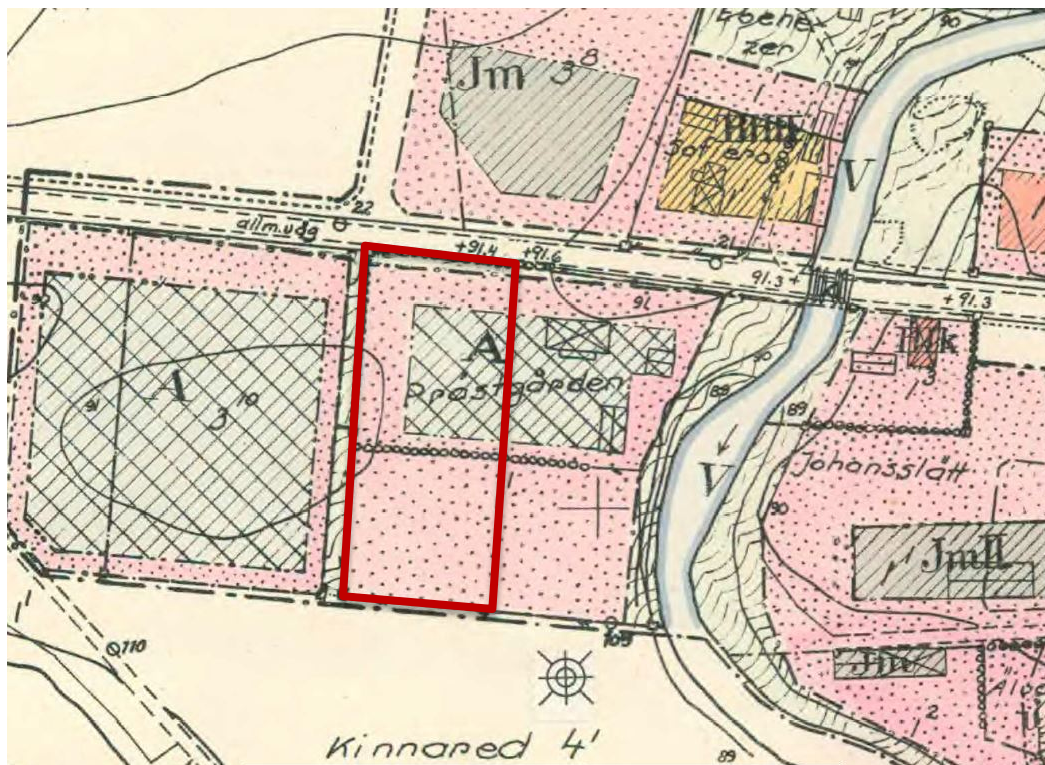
Utsnitt ur gällande/underliggande detaljplan med aktuellt område avseende ändring av detaljplan. Ungefärlig planavgränsning är markerad med röd rektangel.
